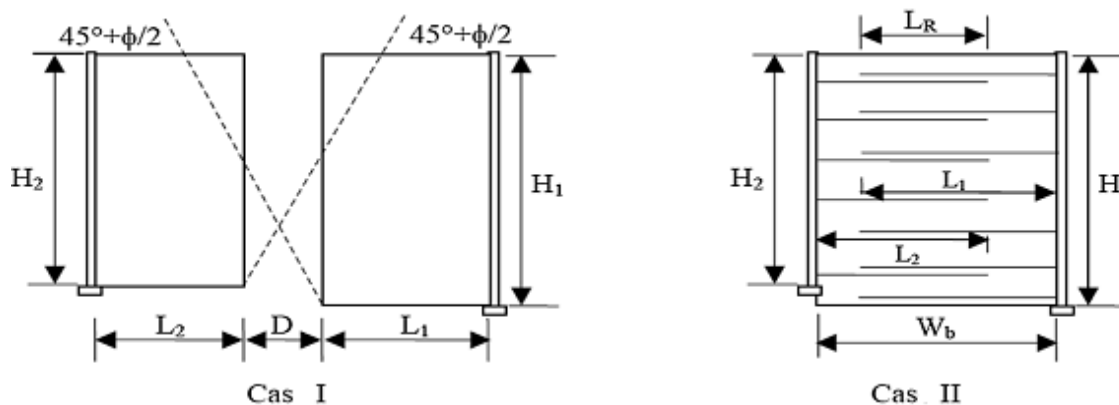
Conception des murs à double parement (FHWA, 2009)
